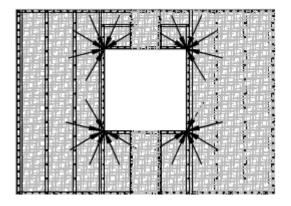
Tensiones que actúan sobre placas en *Steel Frame*. Fuente: (ConsulSteel, 2014).
